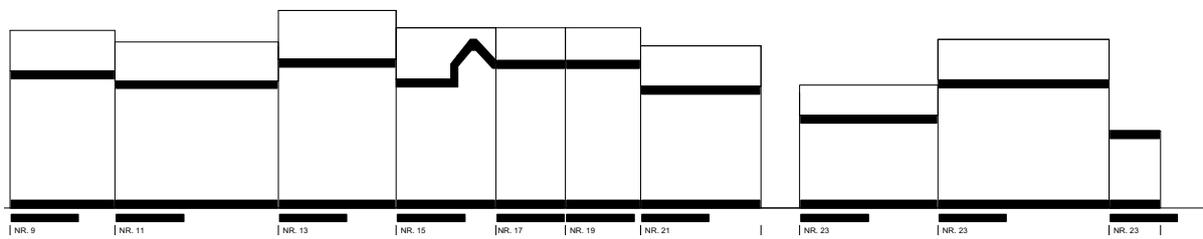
Fassadengestalt Hauptstraße 9 - 23
